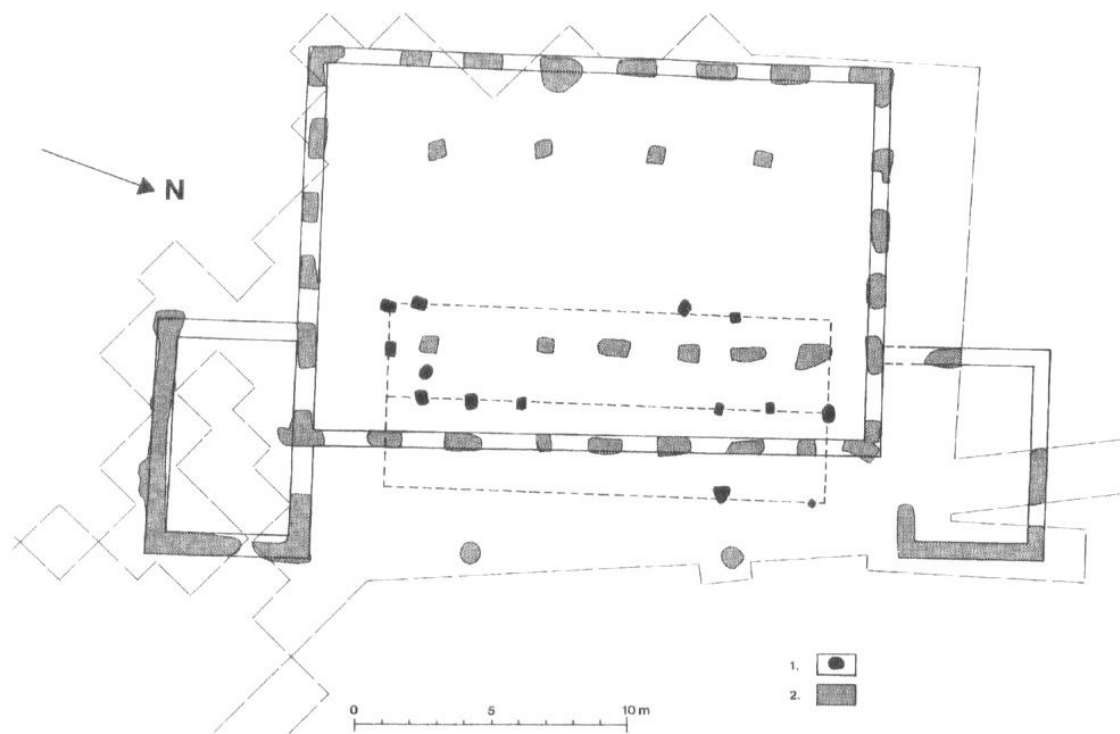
Heestert (W. Fl.) Vereinfachter Grundriss des Hauptbaus. 1. Postenlöcher des Holzbaus; 2. Steinerr Fundamentierungsreste (Nach JANSSENS, D. M. 1984)
